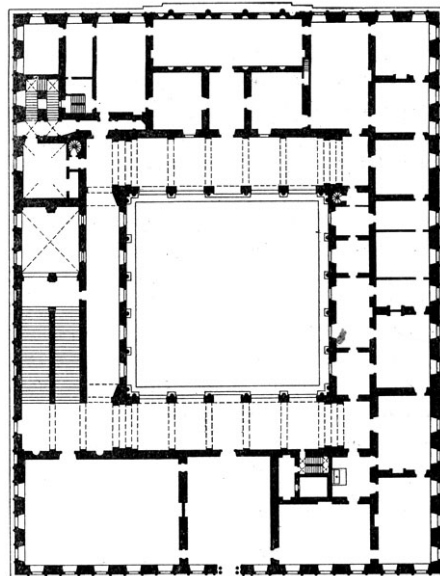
Палаццо Фарнезе в Римі. План 2-го поверху.
